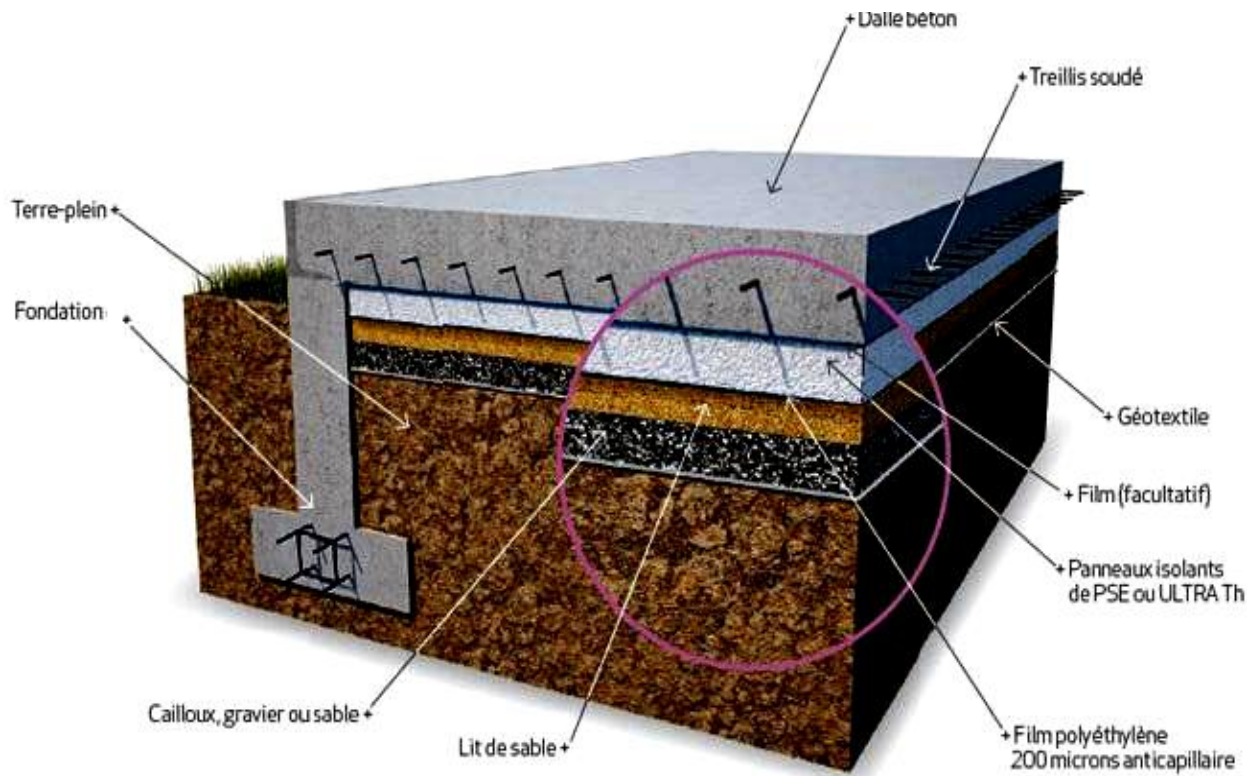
Schéma de ferrailage de la dalle Pleine.
